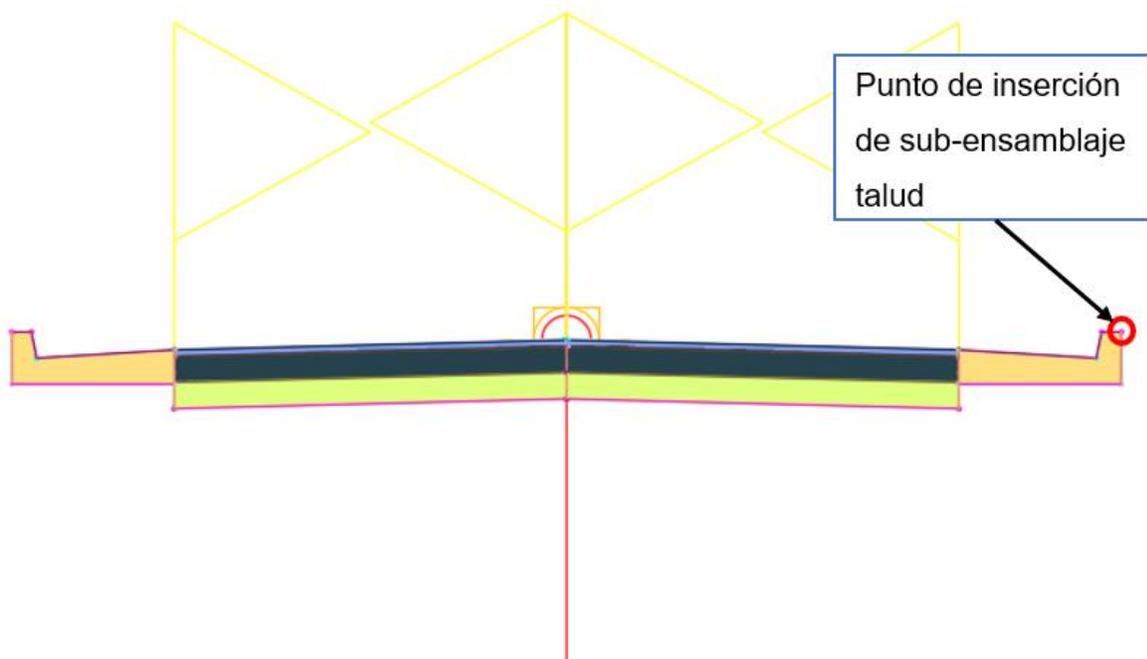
Vista de sub-ensamblajes carril y cuneta
